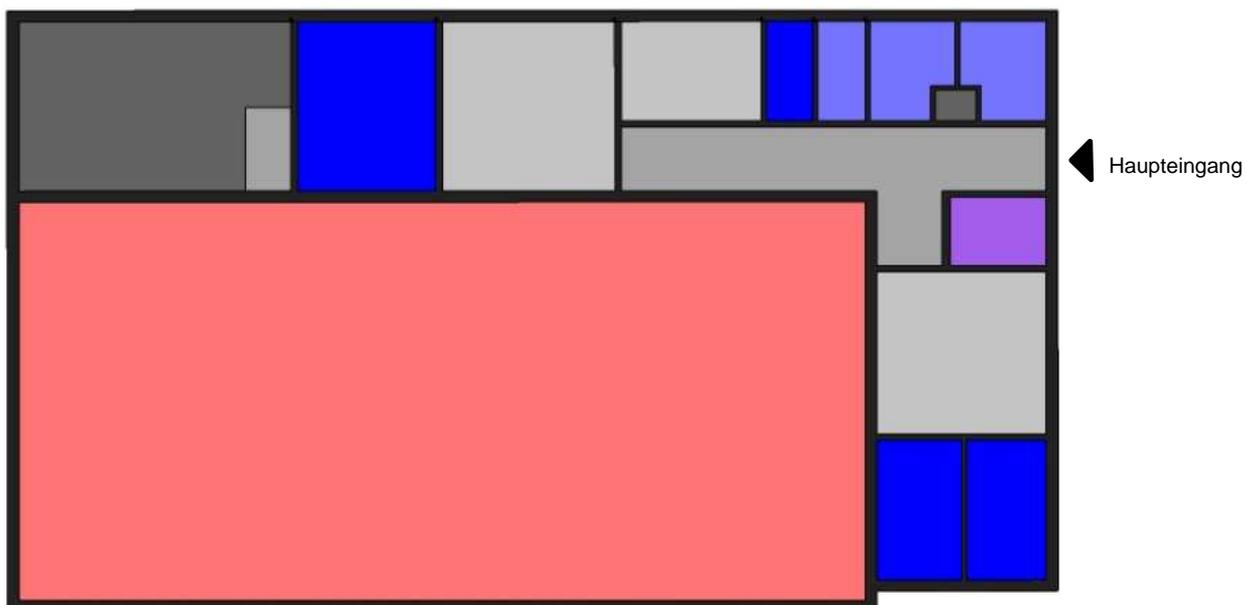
Turnhalle, Grundriss mit Zonierung
